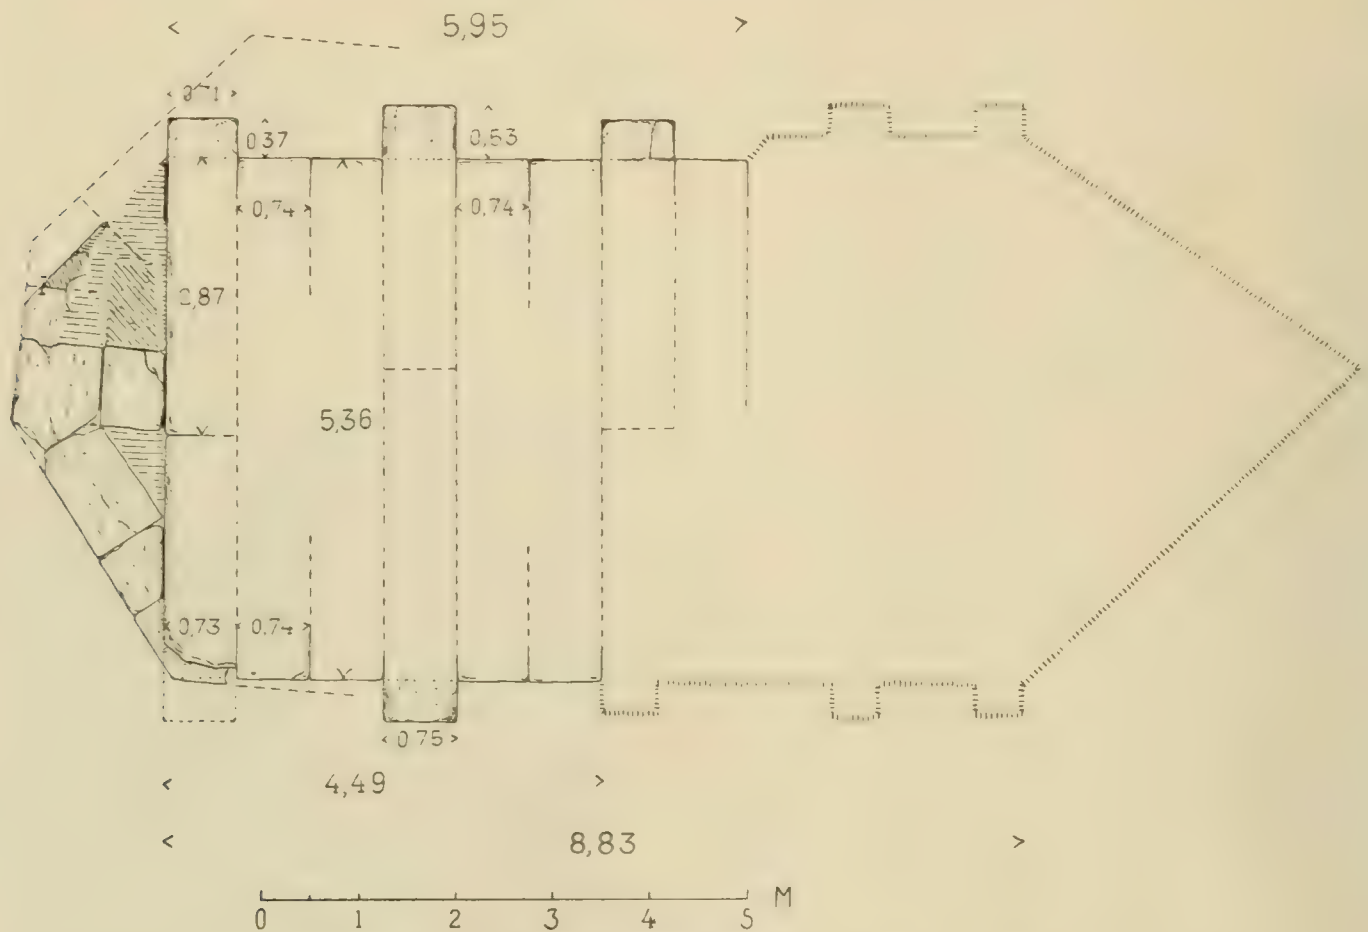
Plan des erhaltenen Strompfeilers; 1:100.
